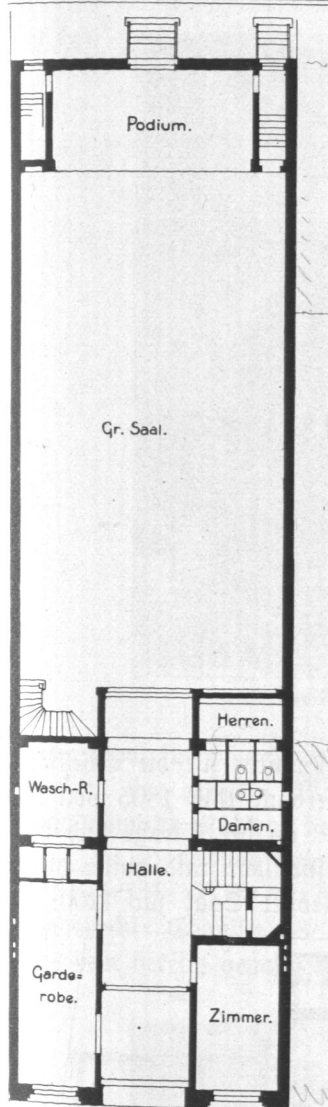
Volksheim Sachsenstraße, Erdgeschoß, Grundriß.
